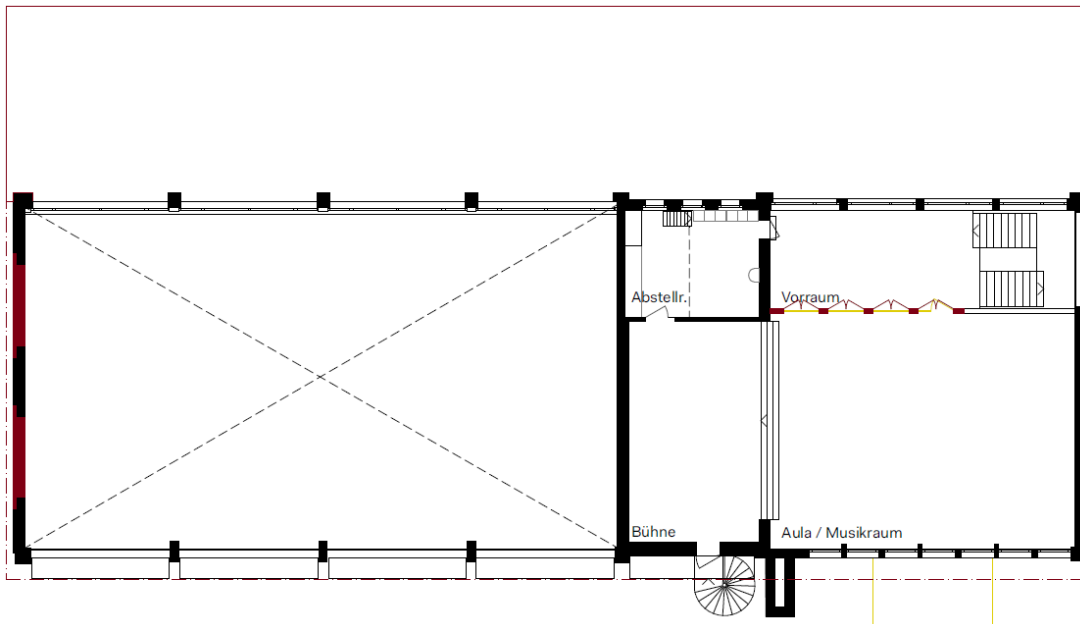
Hallentrakt - Grundriss Obergeschoss mit Aula
